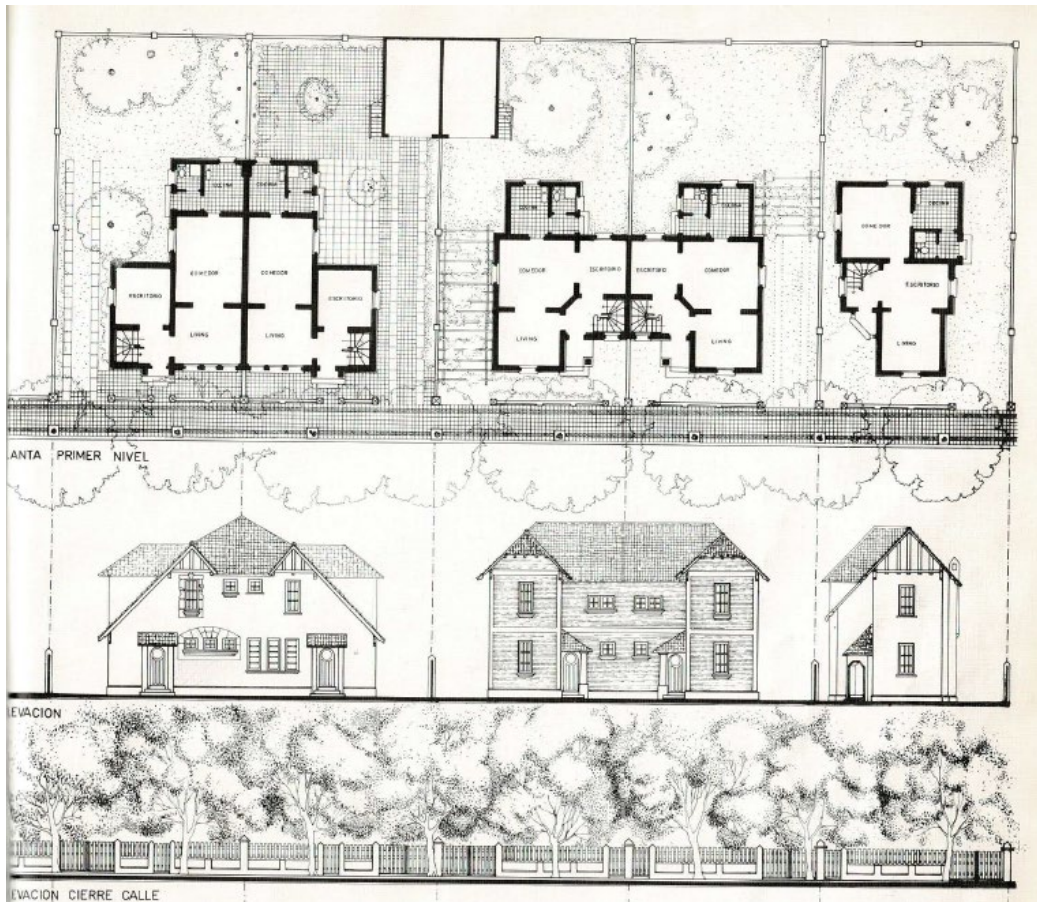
Planimetría de la población en su origen. Fuente: Palmer, M. (1984).
